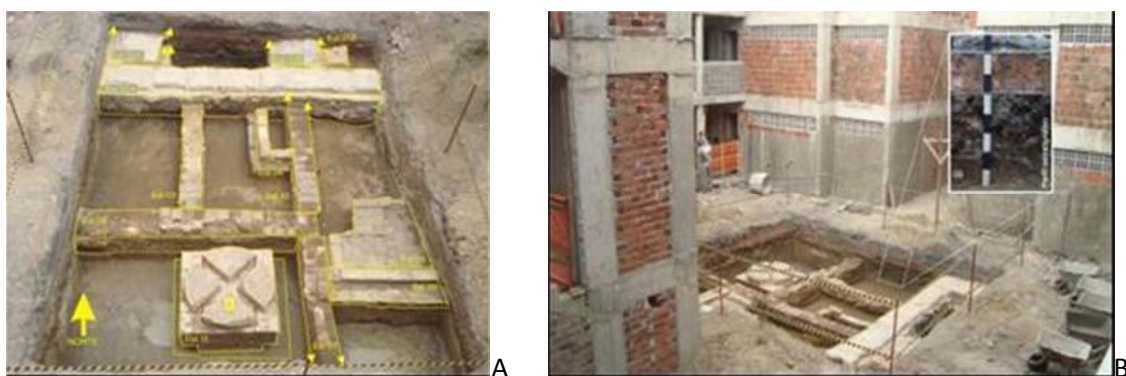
A: Estruturas encontradas na área da construção do bloco C do conjunto habitacional Pilar, na atual área central do Recife; B: Localização das estruturas escavadas em relação à área da cisterna do bloco C do conjunto habitacional Pilar, na atual área central do Recife.
